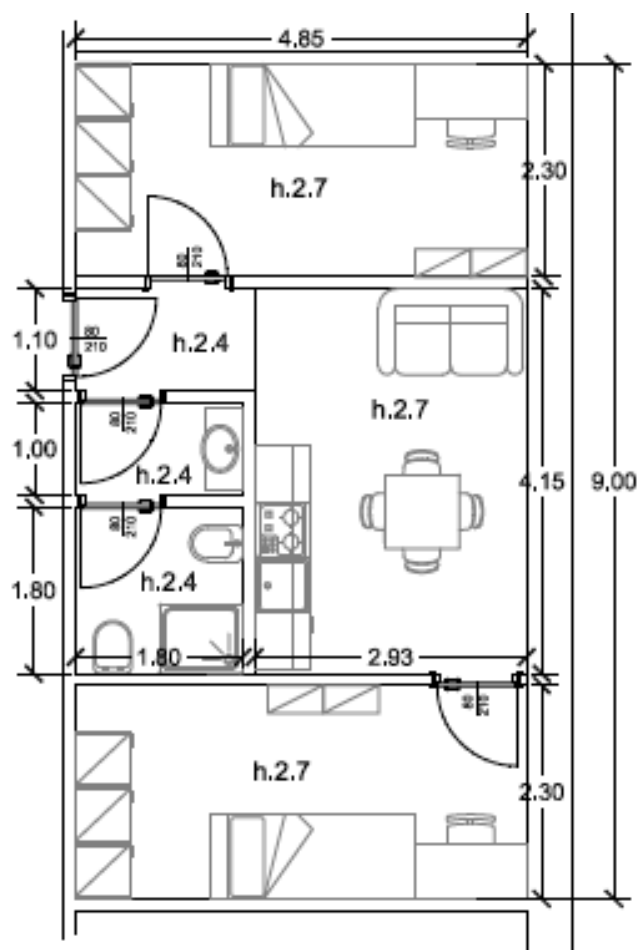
6 – Pianta tipo alloggio in appartamento trilocale con due posti letto - Fonte: elaborazione dell'autore
